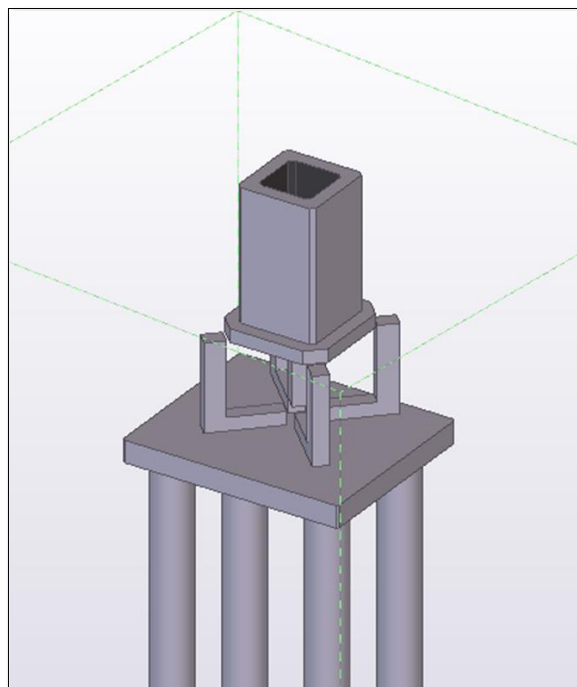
Modelado de pilas, zapata, contrafuertes, faldón y columna con aligeramiento
